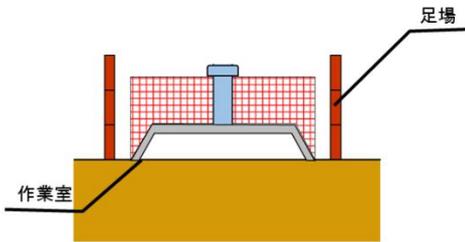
下部工（ニューマチックケーソン基礎形式）の施工手順
